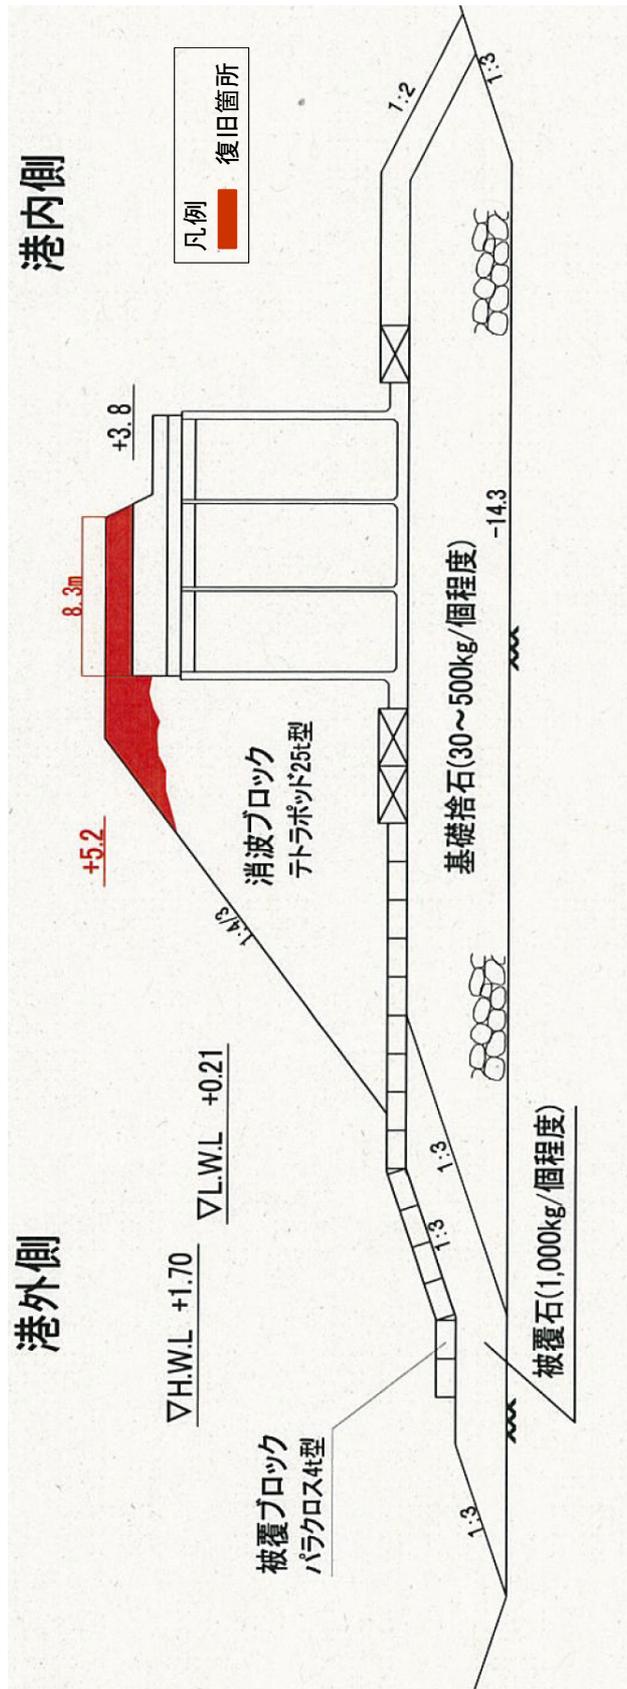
No.1 雲雀野地区 南防波堤の断面図 B-B' (復旧後)
